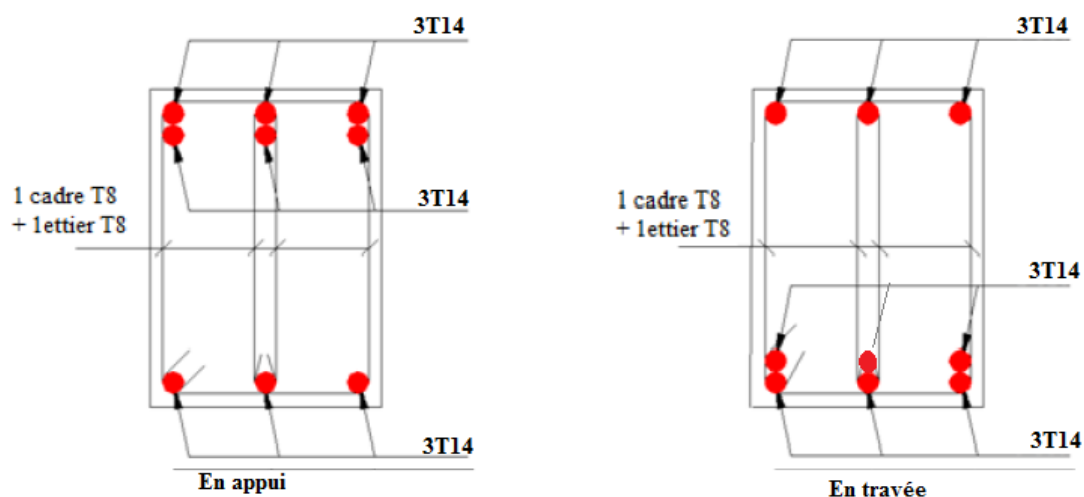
Ferrailage des Poutres non porteuses de RDC, 1^{er}, 2^{ème} et 3^{ème} étages.
